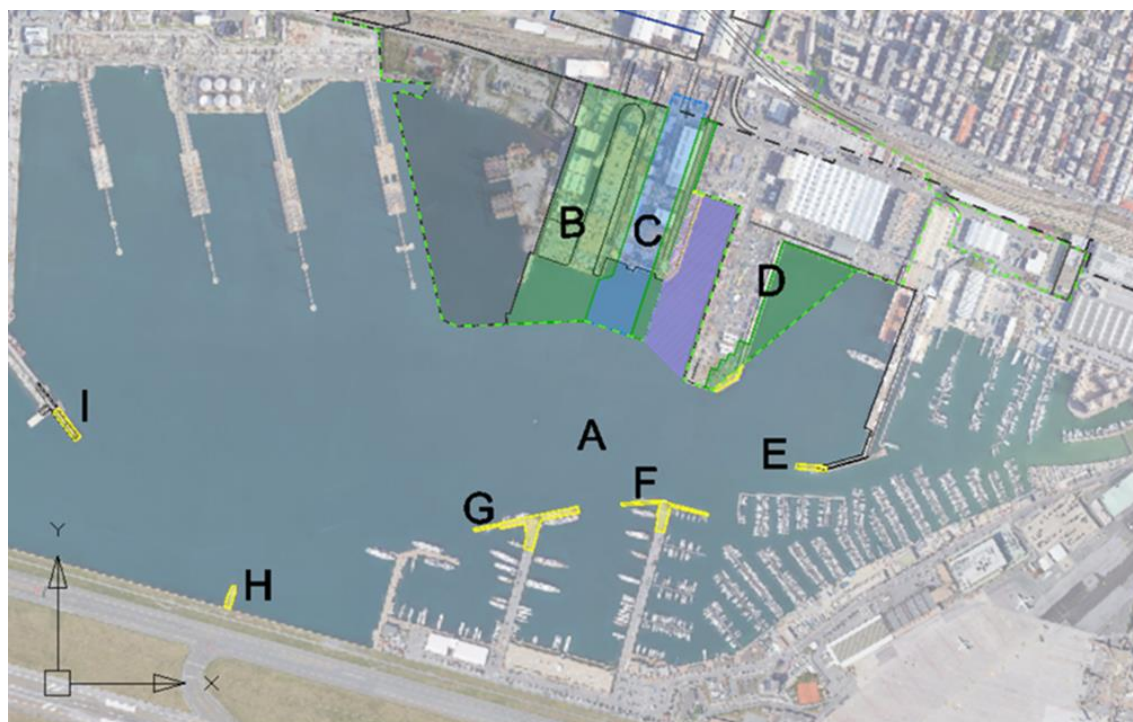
Layout di progetto del bacino di Sestri Ponente
